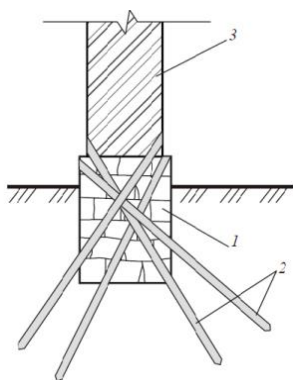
Усиление фундаментов буроинъекционными сваями: 1 – фундамент; 2 – буроинъекционные сваи; 3 – стена
